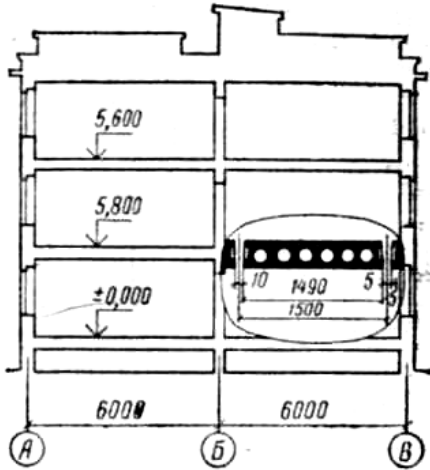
Разрез здания с укладкой панелей сборного перекрытия
